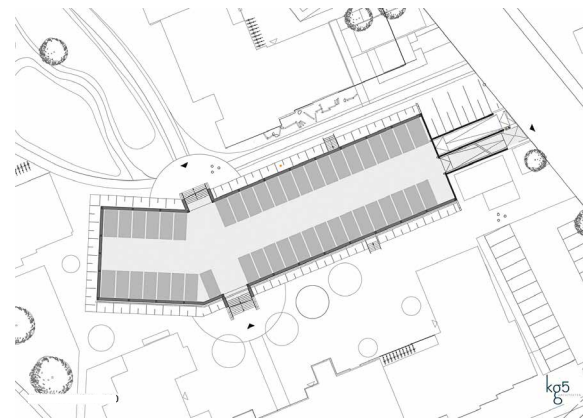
Grundriss UG (© kg5 Architekten)
